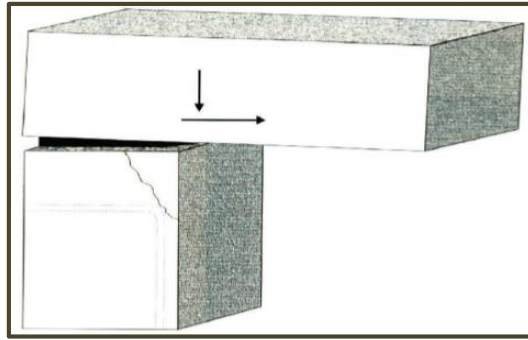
Patrón de fractura de borde, por rigidez del apoyo.
